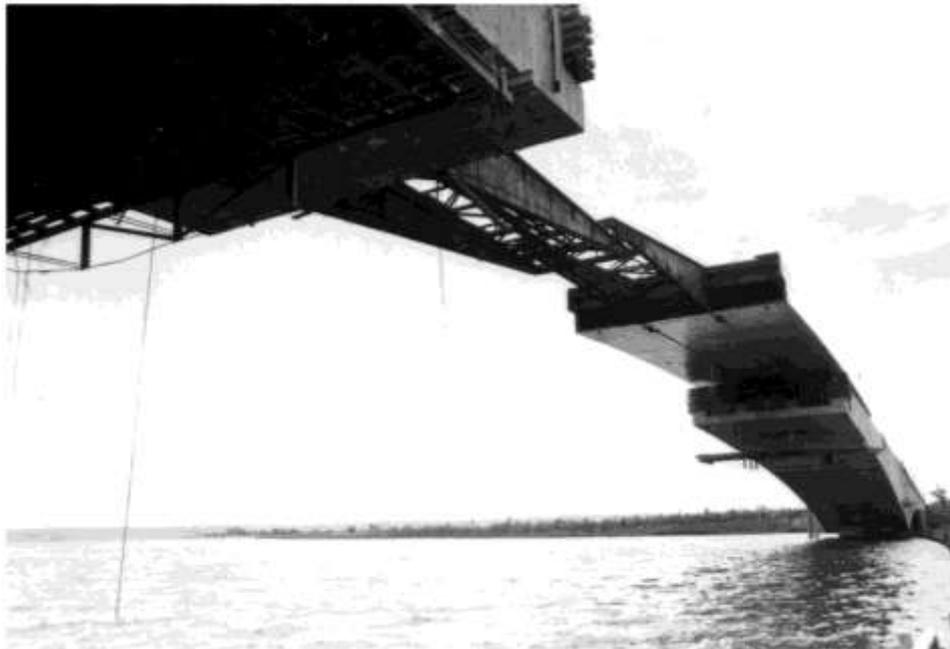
Trecho em estrutura metálica da Viga Gerber, 16/01/76. Fonte: (Arquivo Público do DF, 1976).
